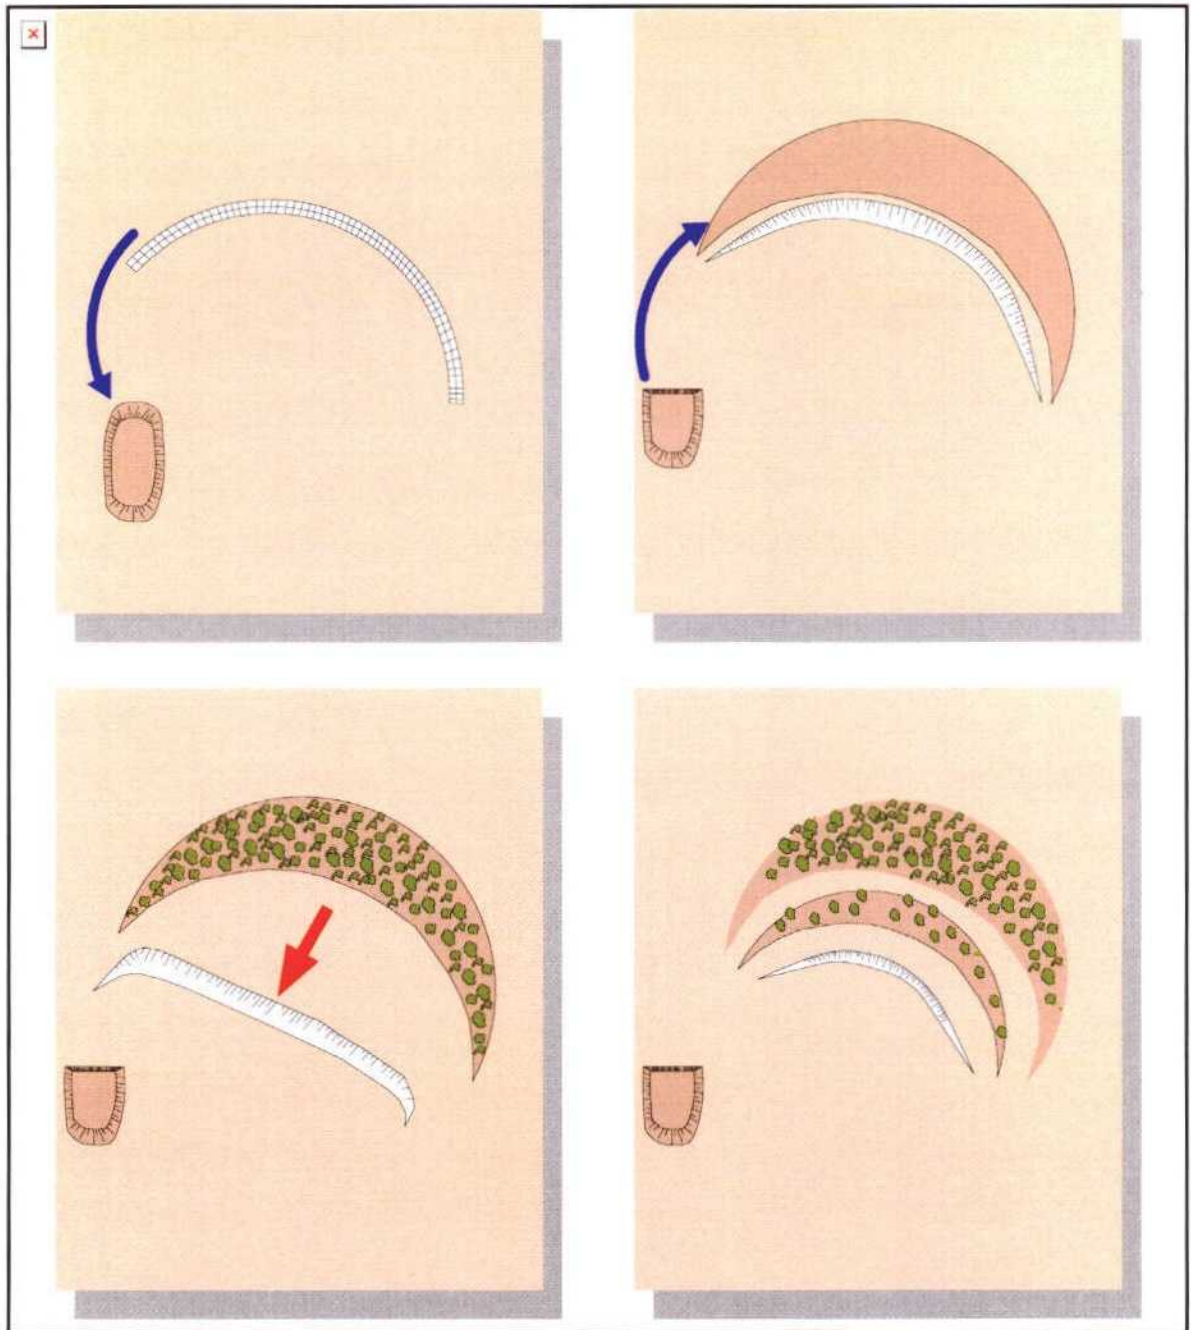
Esquema en planta del proceso de construcción de las escombreras
